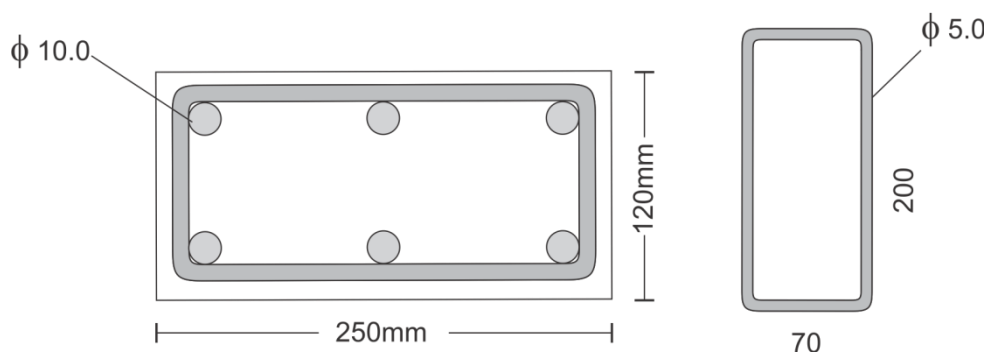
Seção transversal dos pilares ensaiados por Melo(2009).
